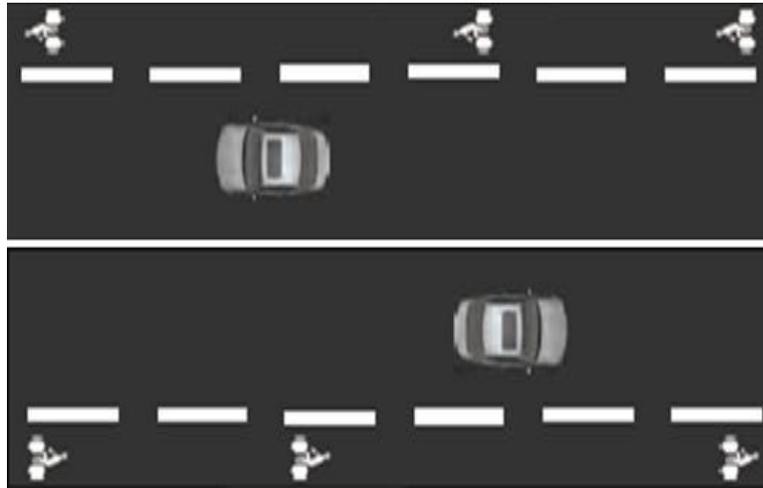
Vue d'en haut d'une proposition d'une chaussée avec piste cyclable
